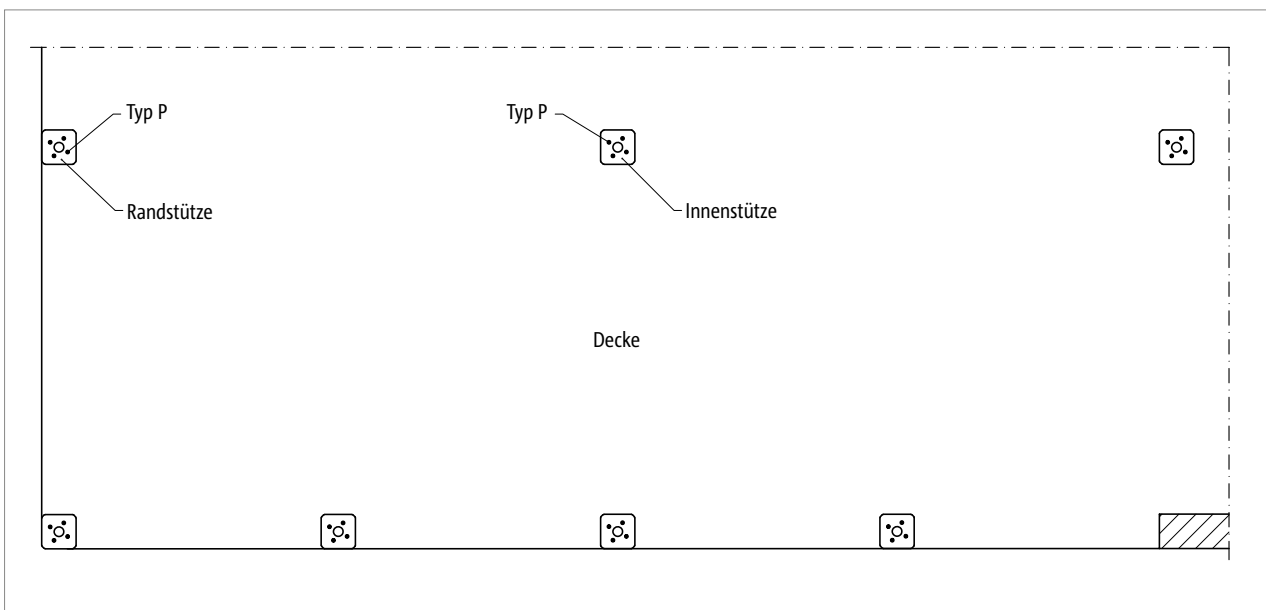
Schöck Sconnex® Typ P: Elementanordnung im Grundriss
